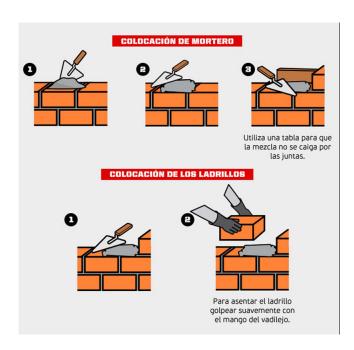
Colocación de morteros Fuentes: : https://www.construyebien.com/ dosificacion-de-materiales
